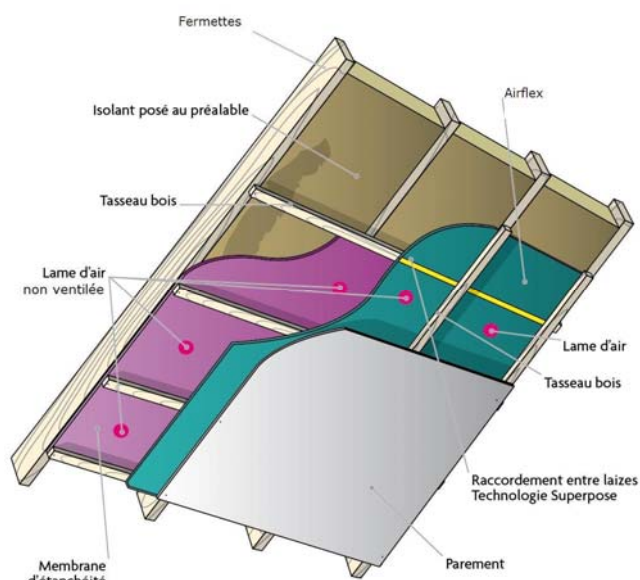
Pose avec 2 lames d'air et membrane d'étanchéité
